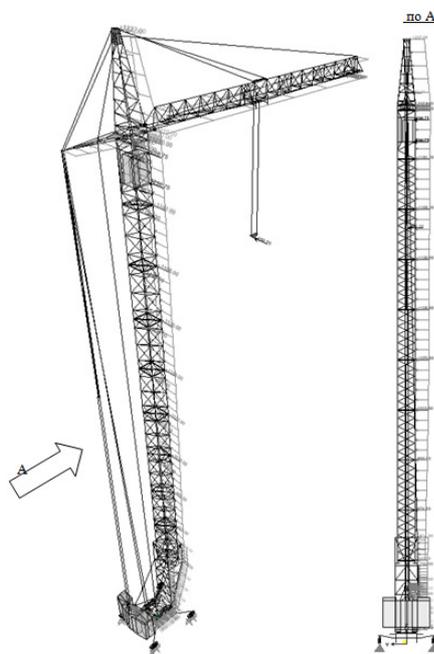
Схема приложения ветровой нагрузки на башенный кран КБМ-401П
